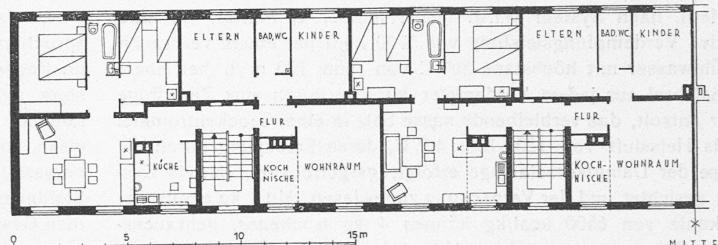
Grundriss-Typen des Ziegelmauerwerk-Baublocks. — 1 : 300.
